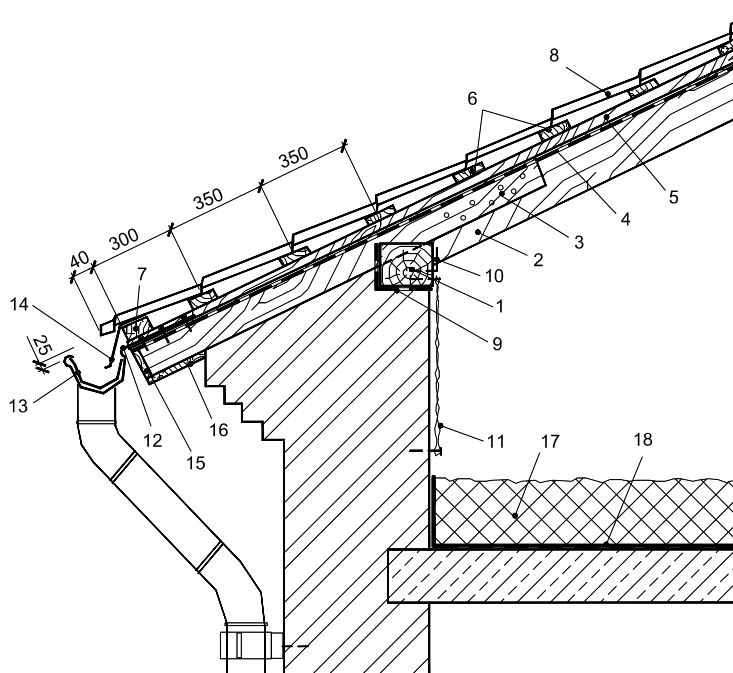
Вариант устройства карниза «теплой» кровли мансардного этажа с водоизоляционным слоем из металлочерепицы
